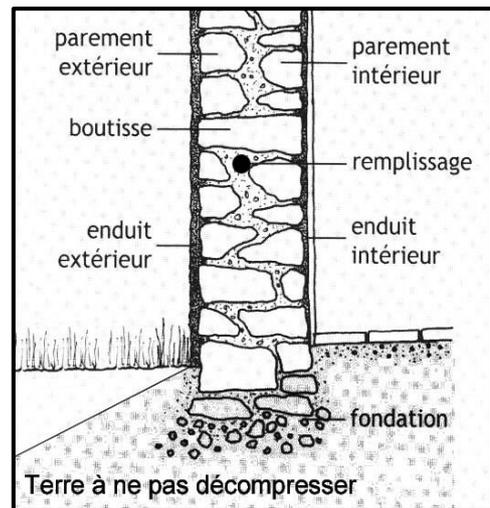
Schéma montrant le détail d'un mur porteur en pierre
